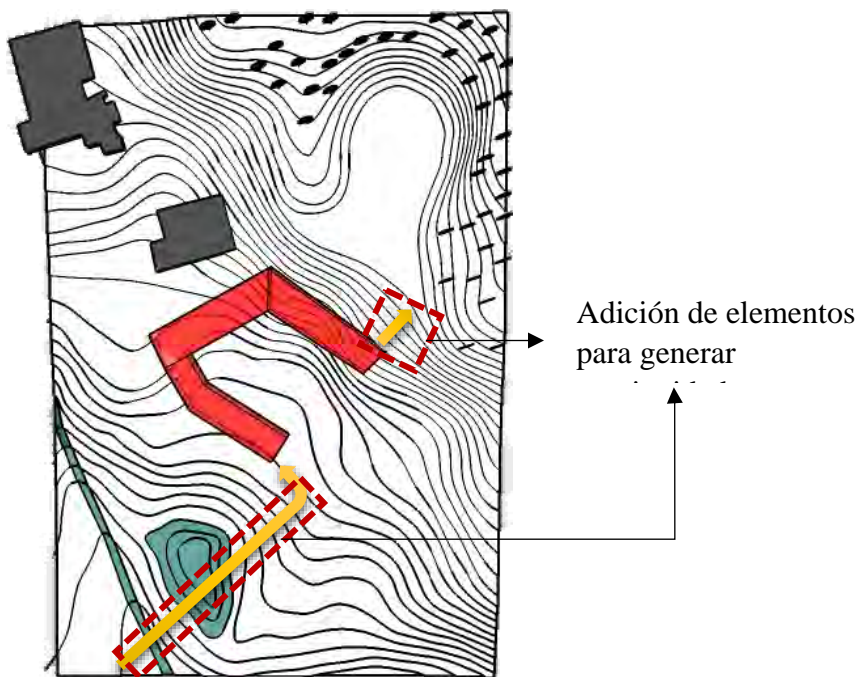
esquema 3 en planta. Fuente: Elaboración propia
